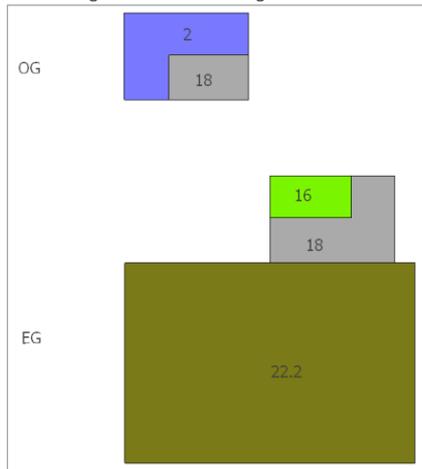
Produktionsgebäude: Grundrisse mit Zonierung
